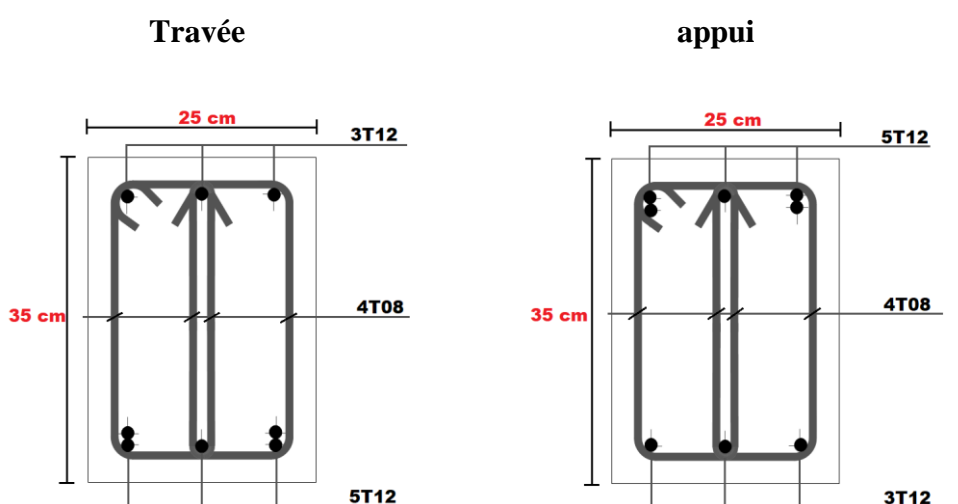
ferrailage de la nervure 25×35 (terrasse).
